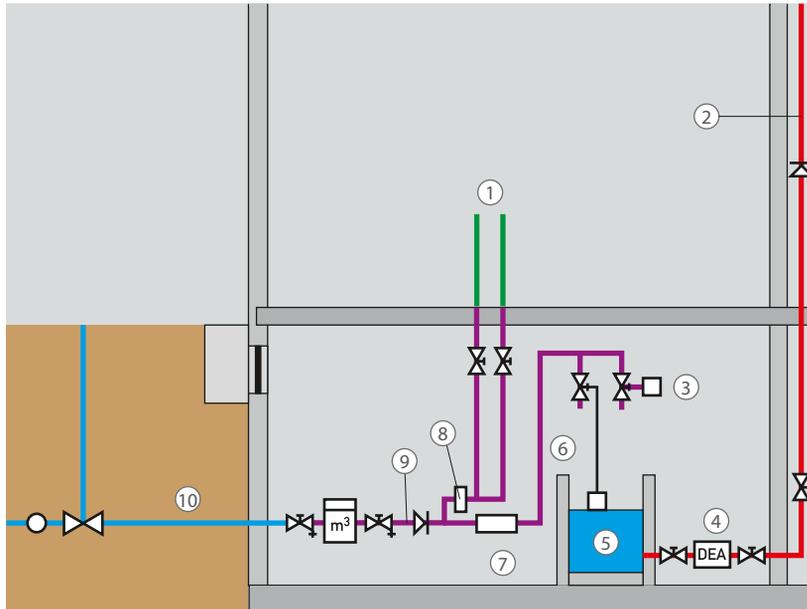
LWÜ mit mittelbarem Anschluss an die Trinkwasser-Installation
